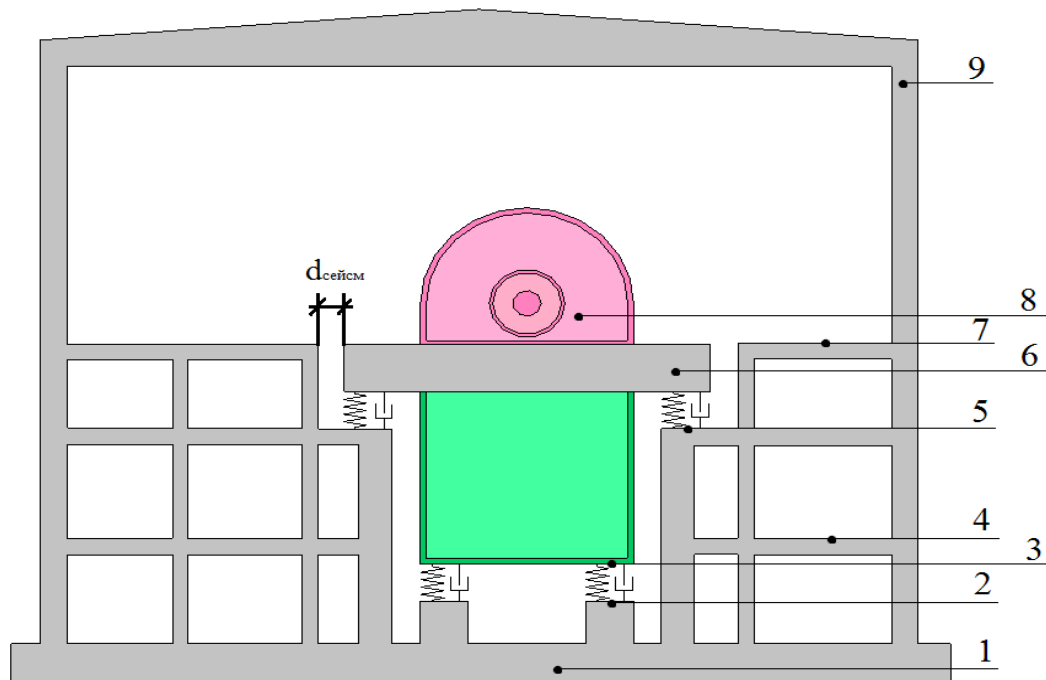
Поперечный разрез здания турбины с виброизолированным фундаментом турбоагрегата
